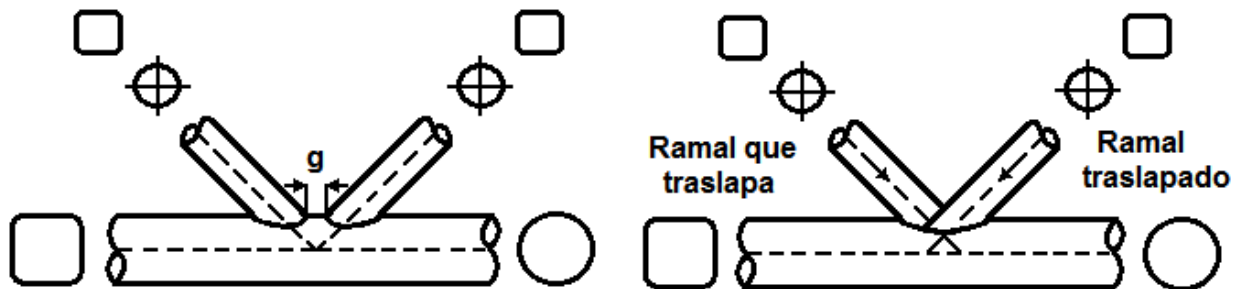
Conexiones PTE a PTE en armaduras (149)
